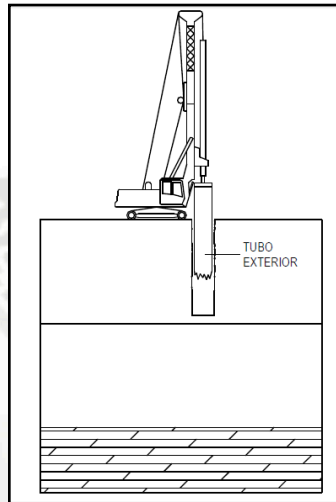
, colocación de la camisa para evitar posibles derrumbes en el interior de la perforación.
